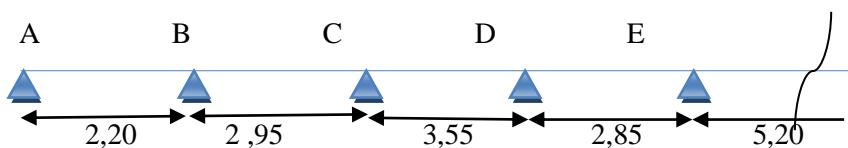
Les types des poutrelles de Terrasse inaccessible.
